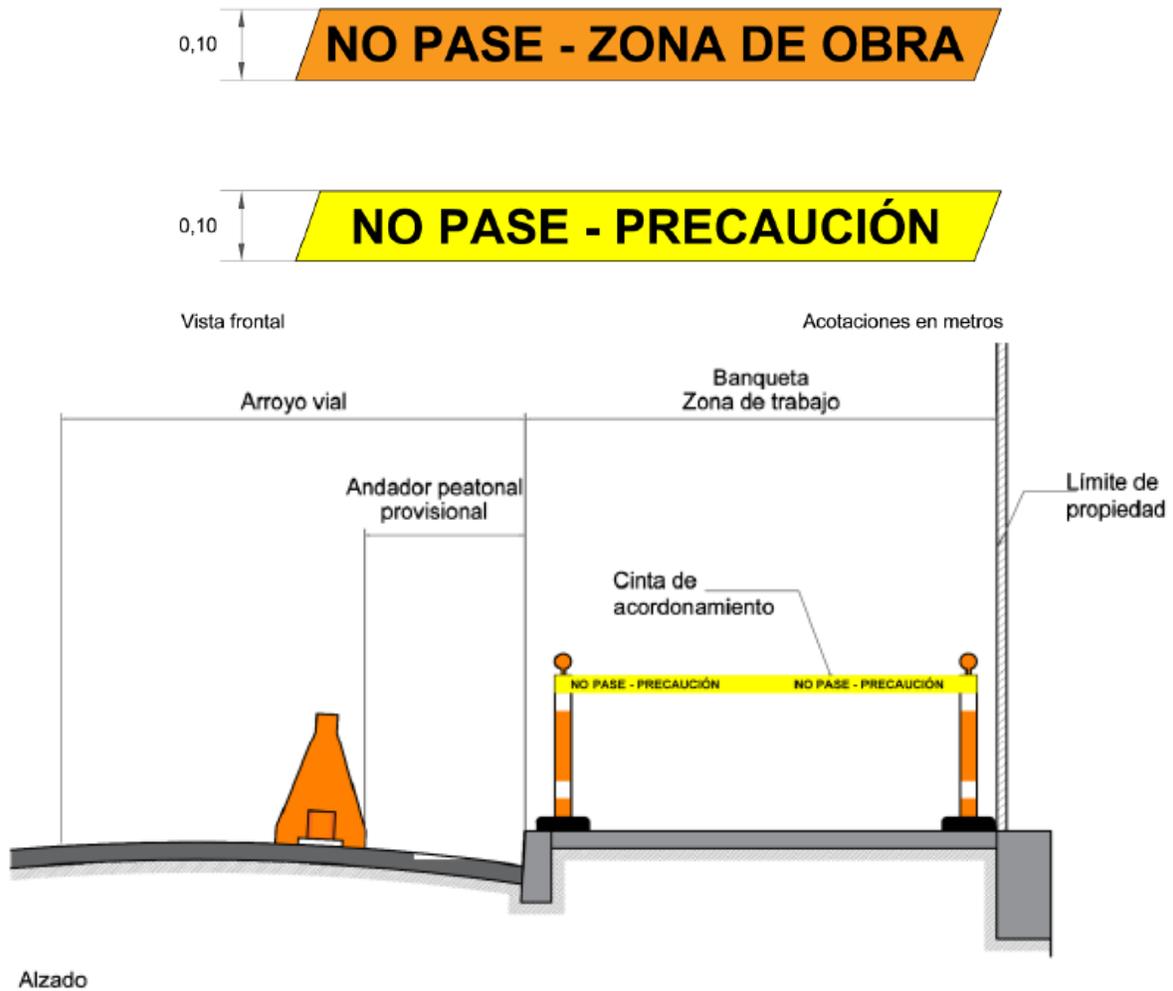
Tipos de acordonamiento en zonas de obra, con cinta
